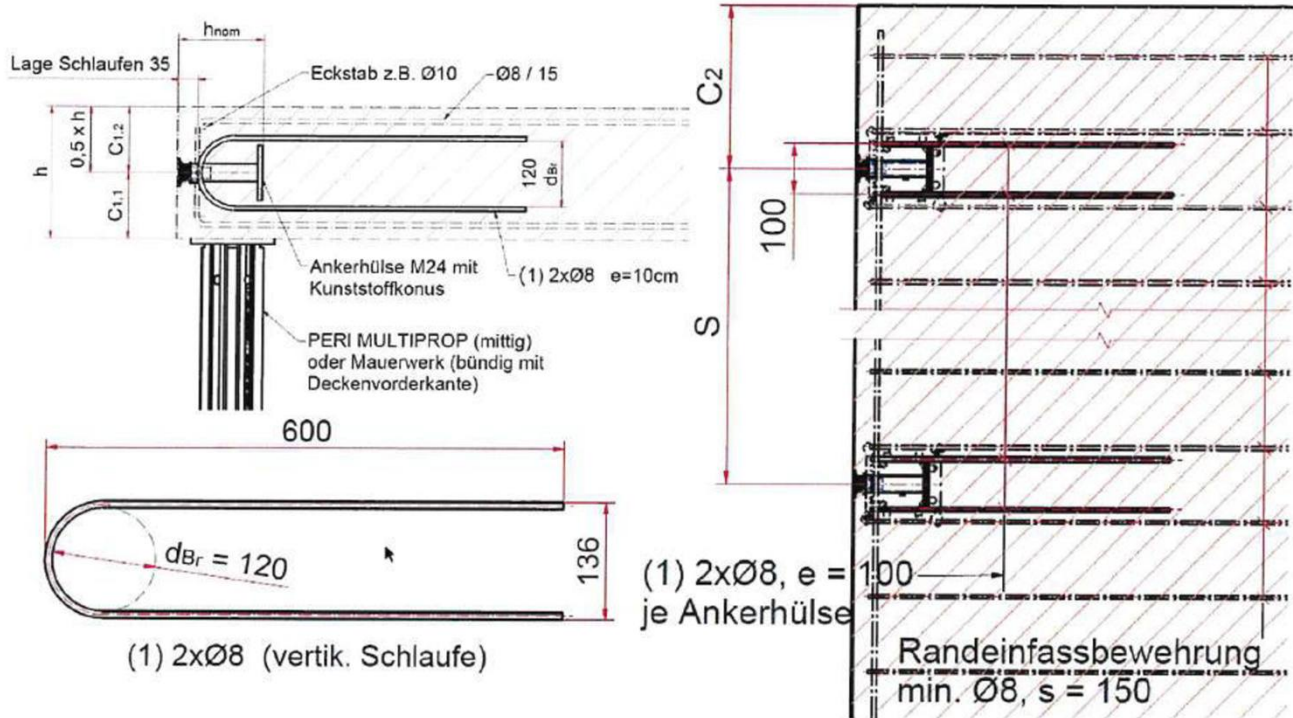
Lage und Darstellung der Verankerung und Zusatzbewehrung bei der Verankerung in der Deckenstirnseite; erforderliche Einfassbewehrung Deckenrand.
